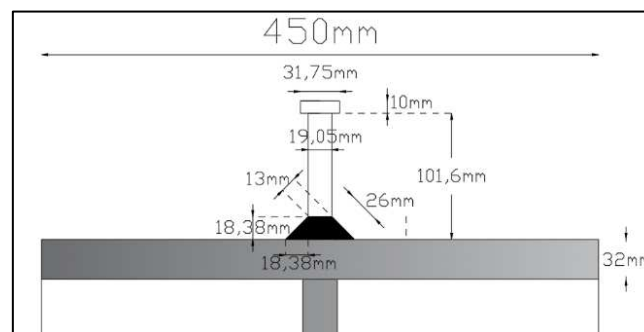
Soldadura de filete entre Patín Superior y el Conector de Corte.
